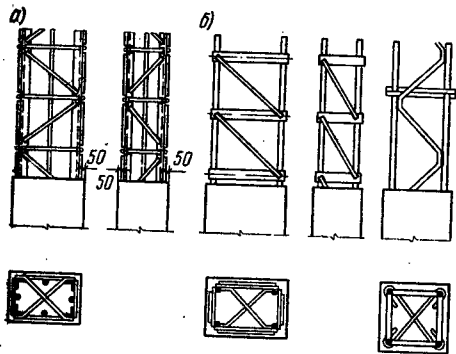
Колонны с несущей арматурой из сварных каркасов; продольные элементы каркасов
